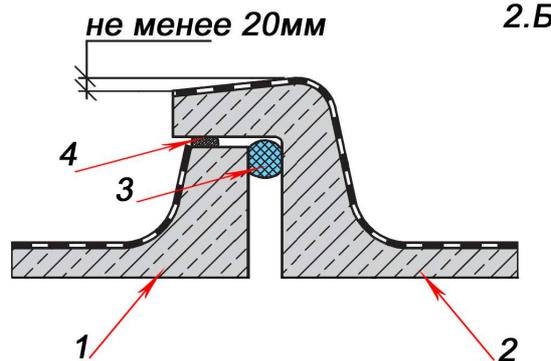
А. Стык кровельных панелей с перекрытием П-образным нащельником:
